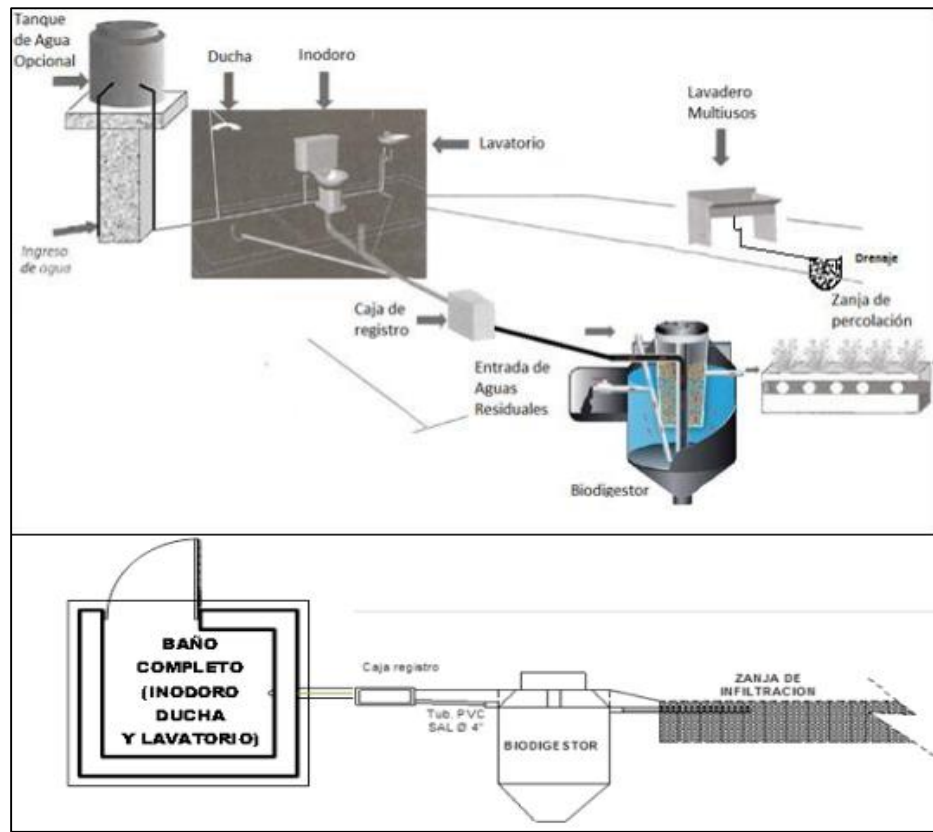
Vista en corte y planta UBS con Biodigestor
